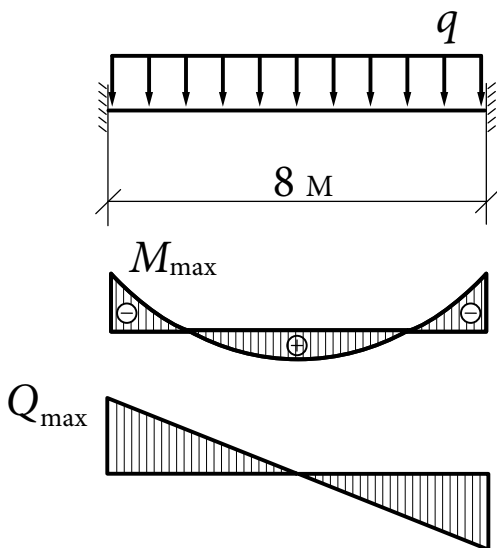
Расчетная схема и эпюры внутренних усилий
